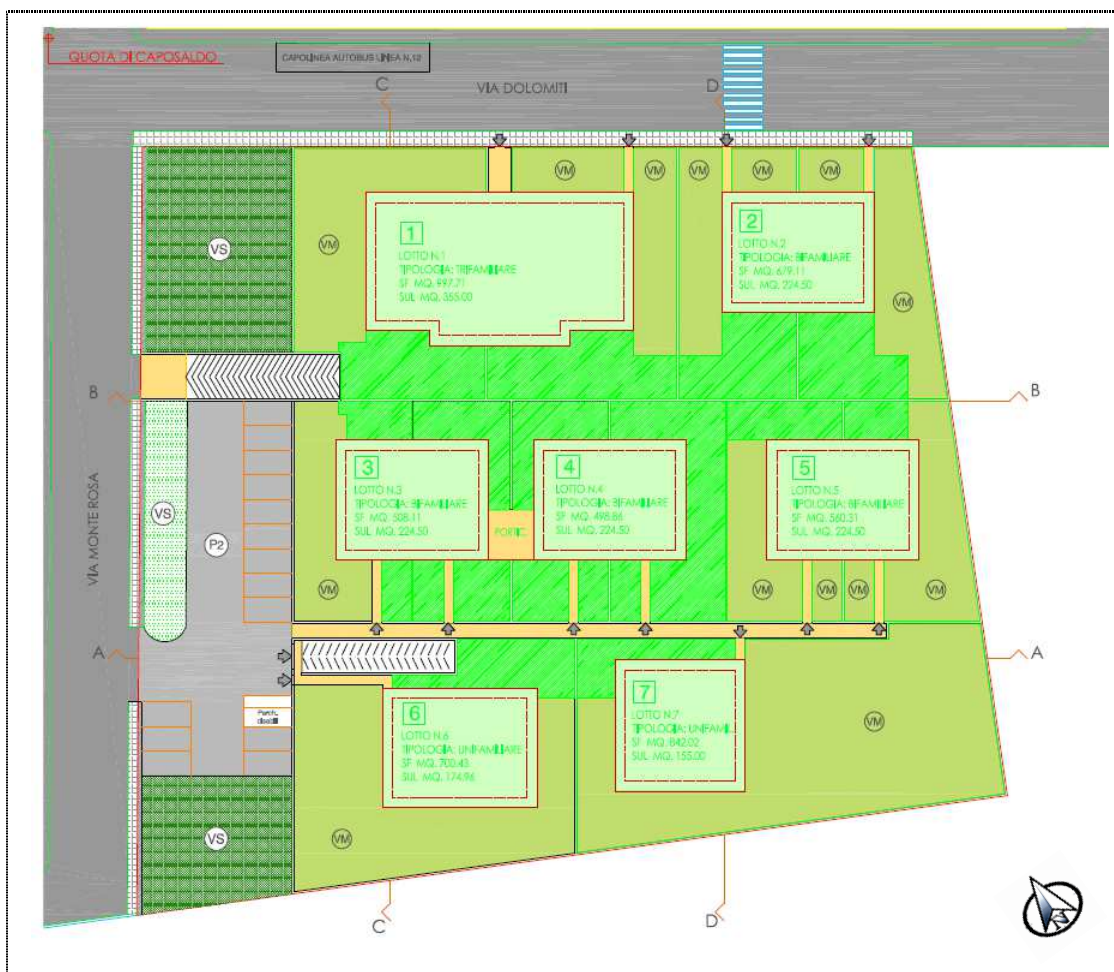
Estratto planimetrico del Piano Urbanistico Attuativo in progetto.
